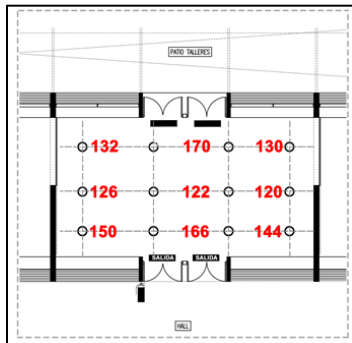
y 8. Planimetría General del Edificio con ubicación del local y Planta General del Aula
